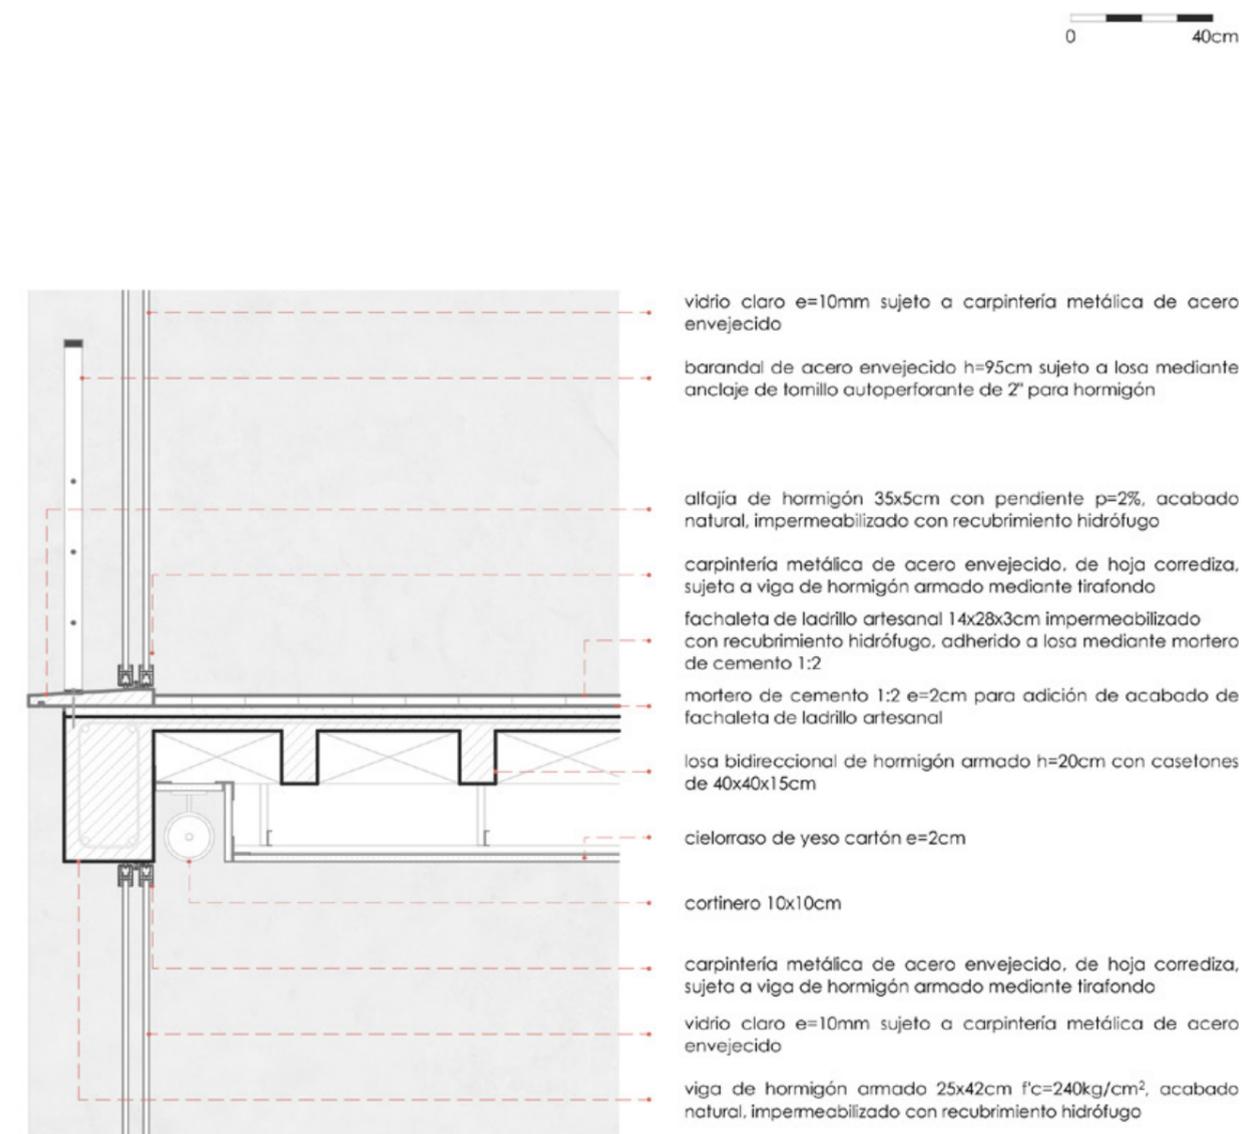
Detalle constructivo 3. Fuente: Elaboración propia.
